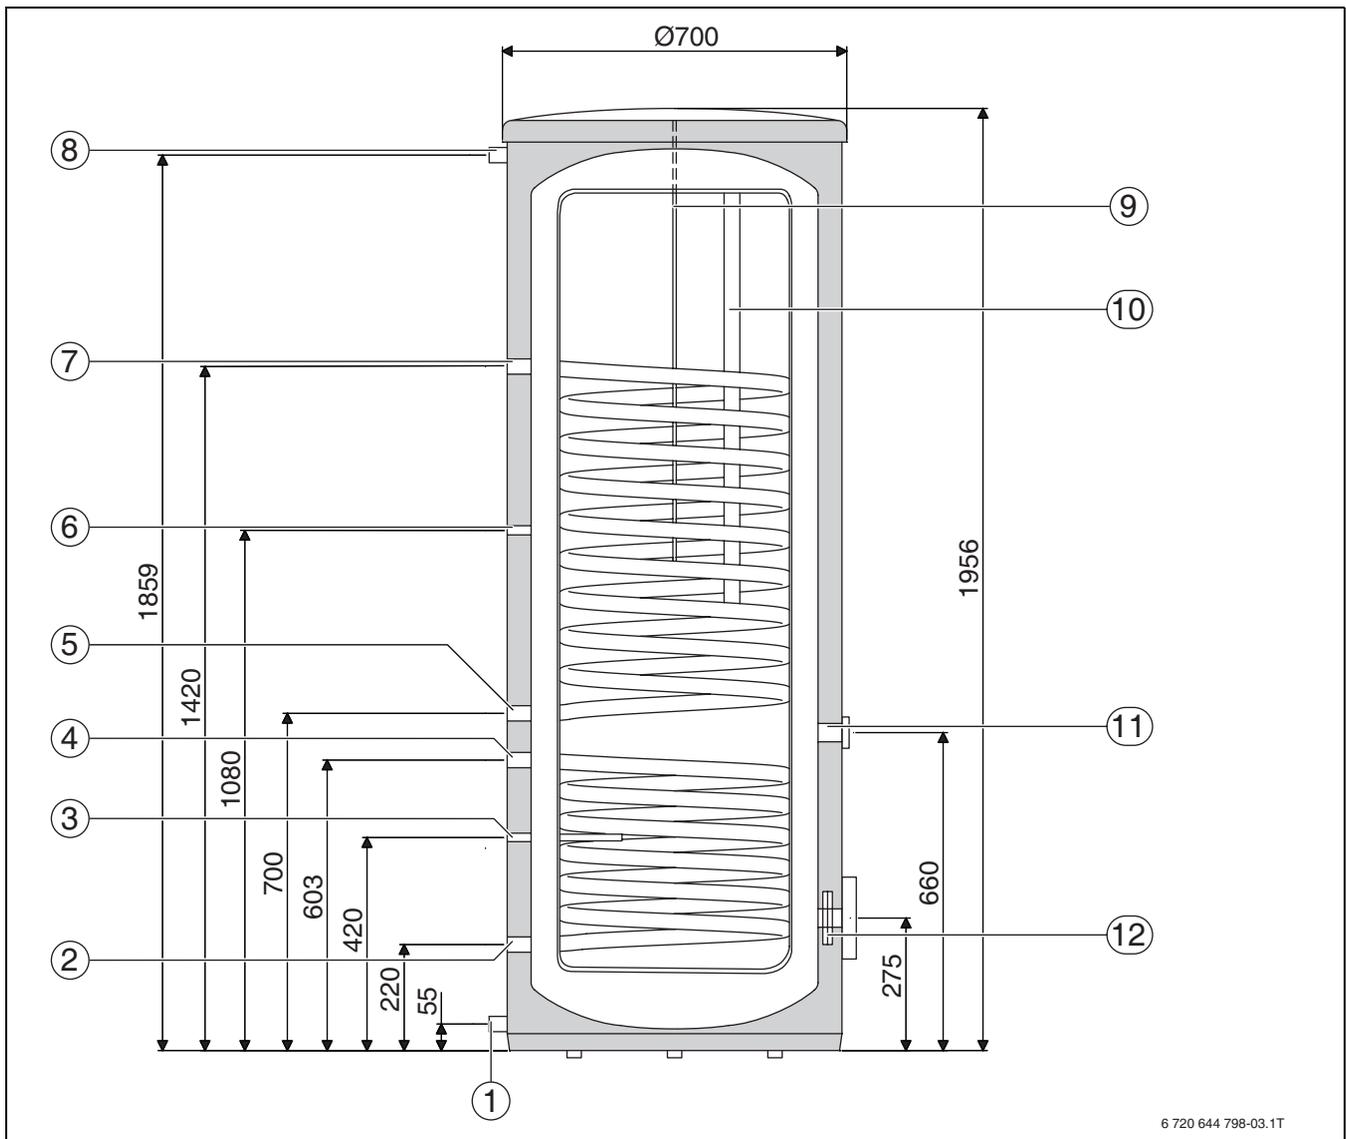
Abmessungen und Anschlüsse Logalux SHB 450 EW (alle Maße in mm)
